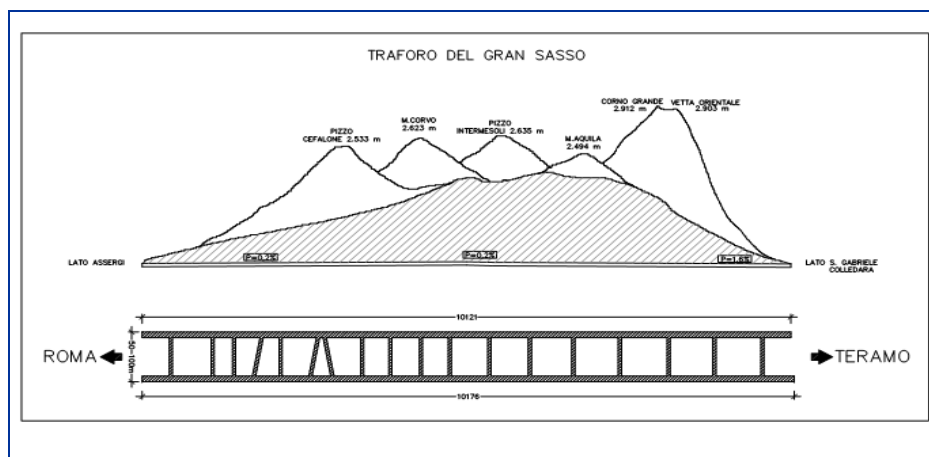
Sezione trasversale e pianta dell'infrastruttura
